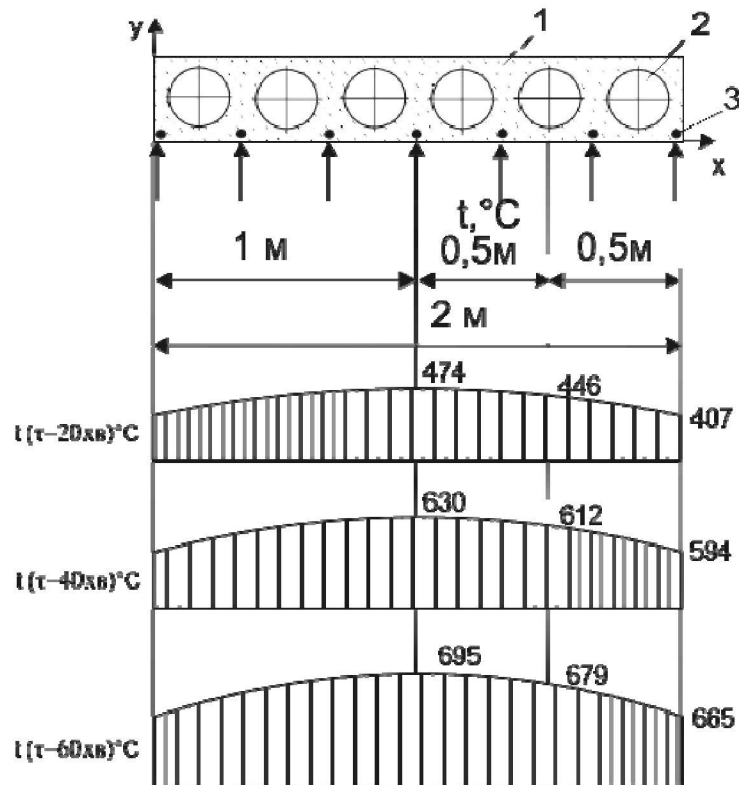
Епюра температури на арматурі ($y=0,02\text{м}$) залізобетонної плити перекриття на 20, 40 та 60 хв пожежі: 1 – бетон; 2 – пустоти; 3 - арматура
